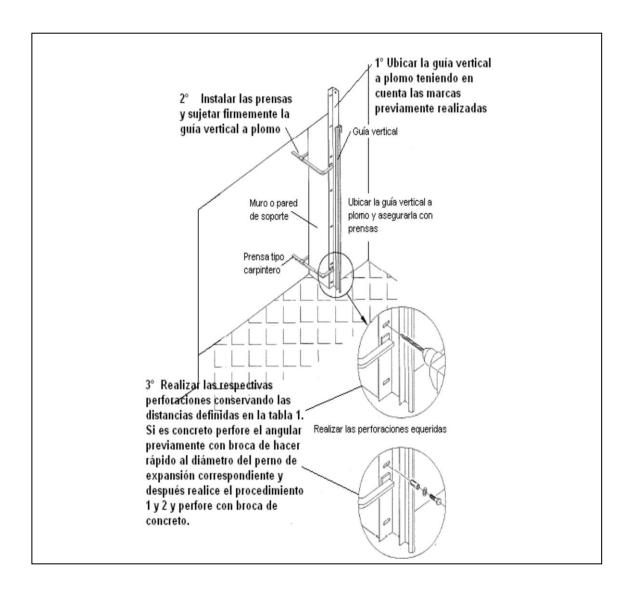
B Montaje guías verticales 1ª Guía Vertical
